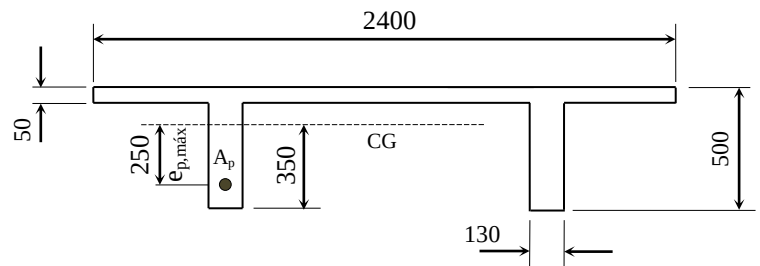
Dimensões (mm) da seção transversal da viga duplo T.
